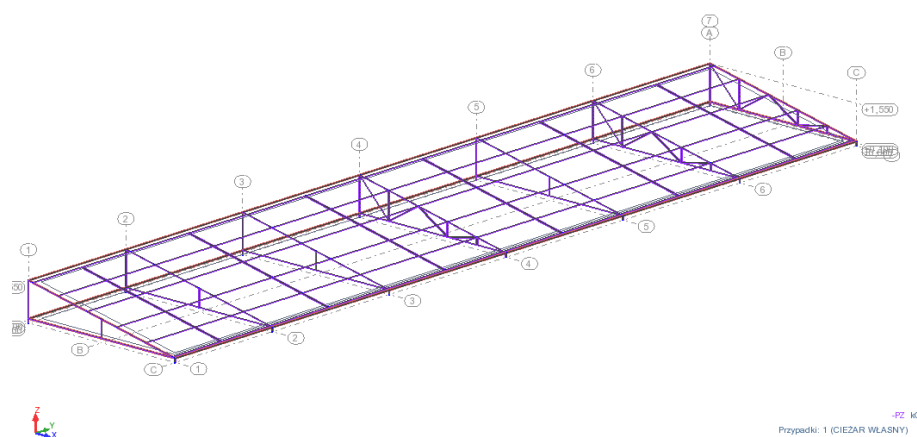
Część I - Widok konstrukcji dachu – widok z boku
